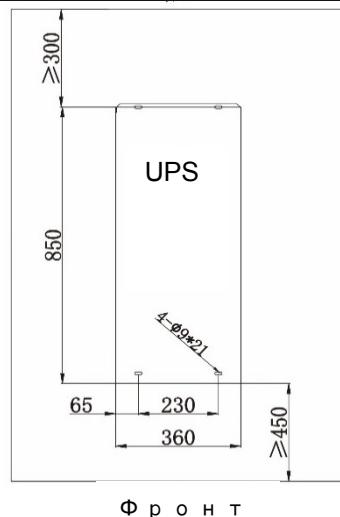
Размеры отверстий для 40/60/80 кВА
